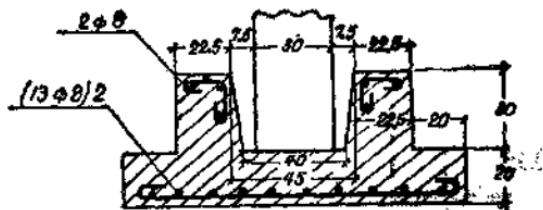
鋼筋混凝土杯槽(柱下面)示意图
